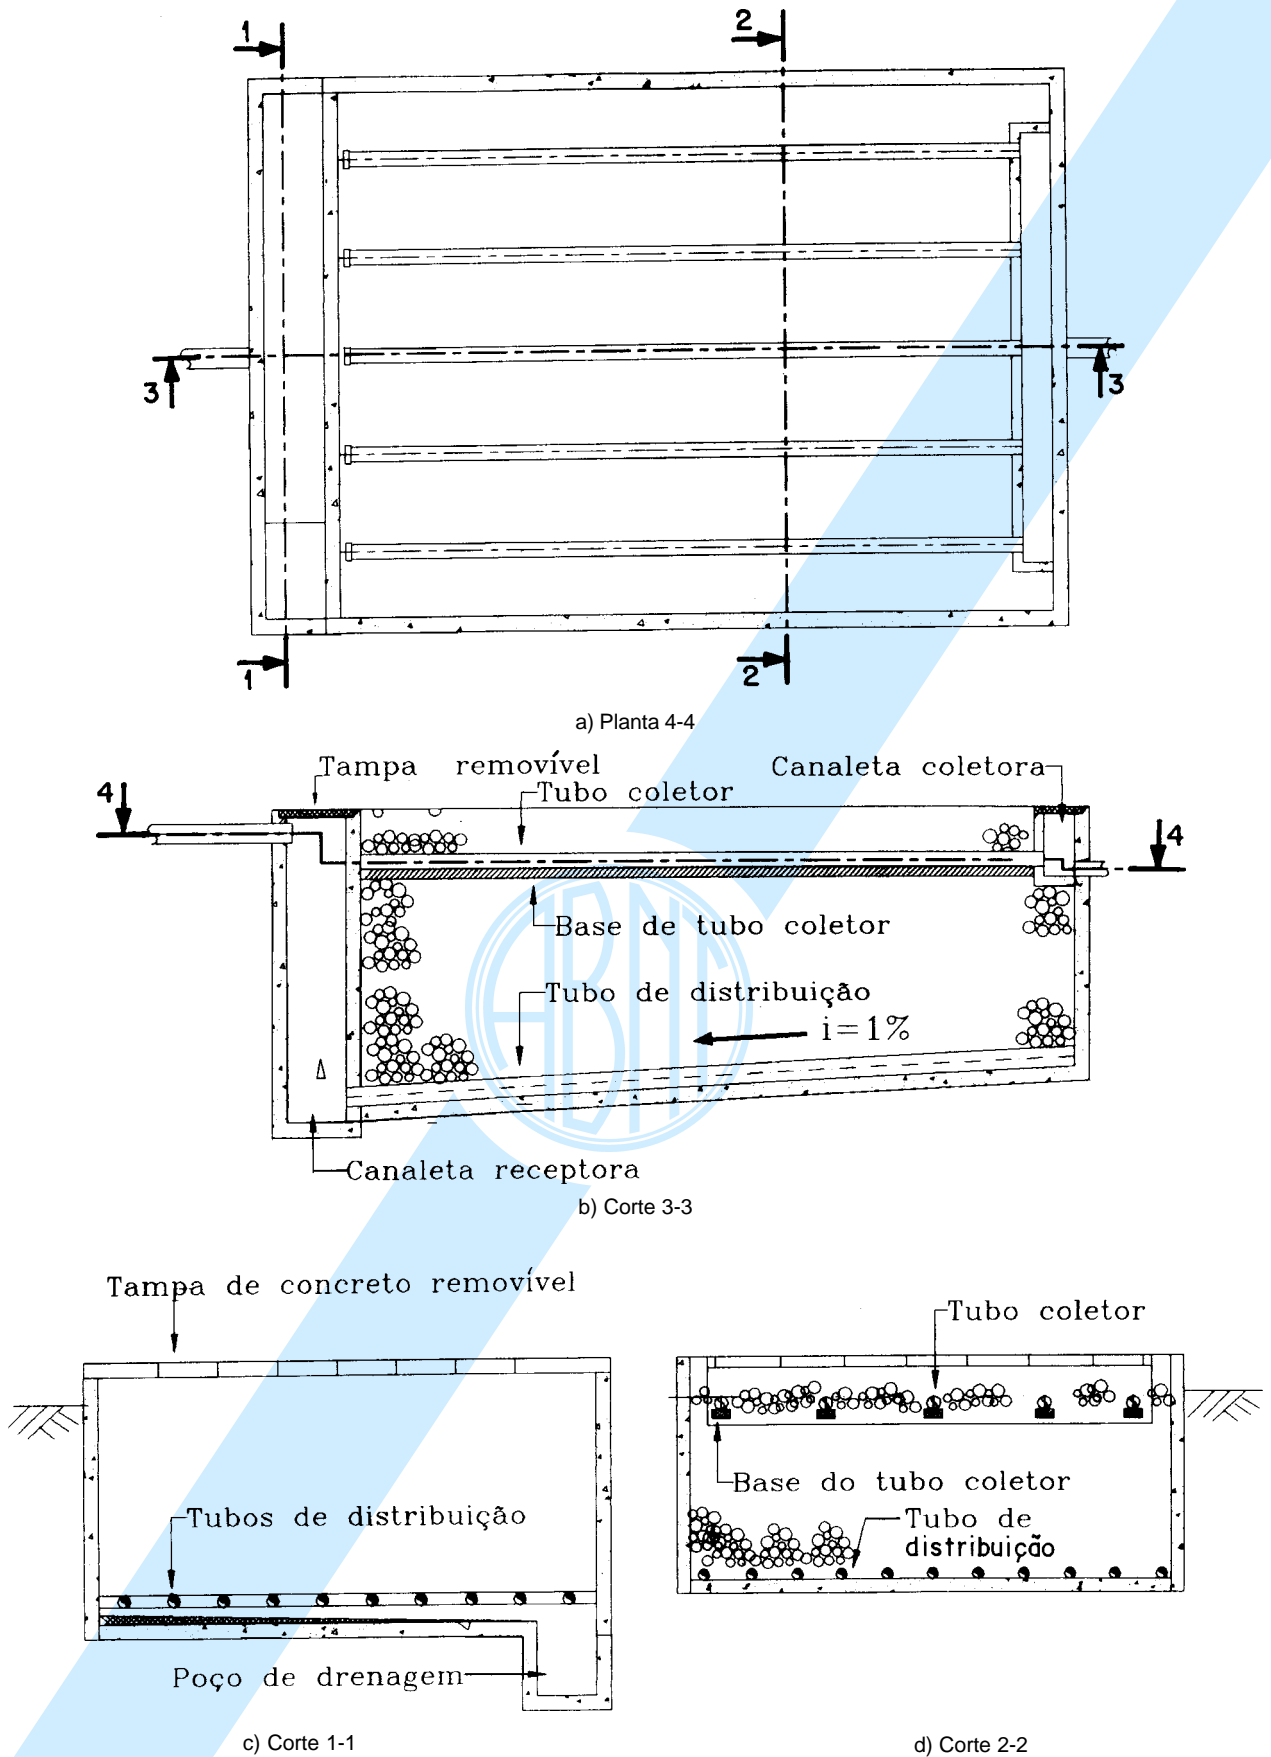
Filtro anaeróbio tipo retangular totalmente enchido de britas (sem laje de concreto)
